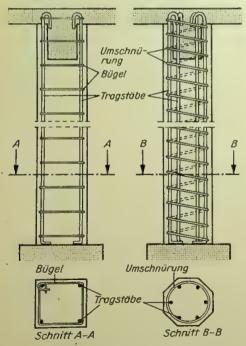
Bügelbewehrte und umschnürte Stütze
